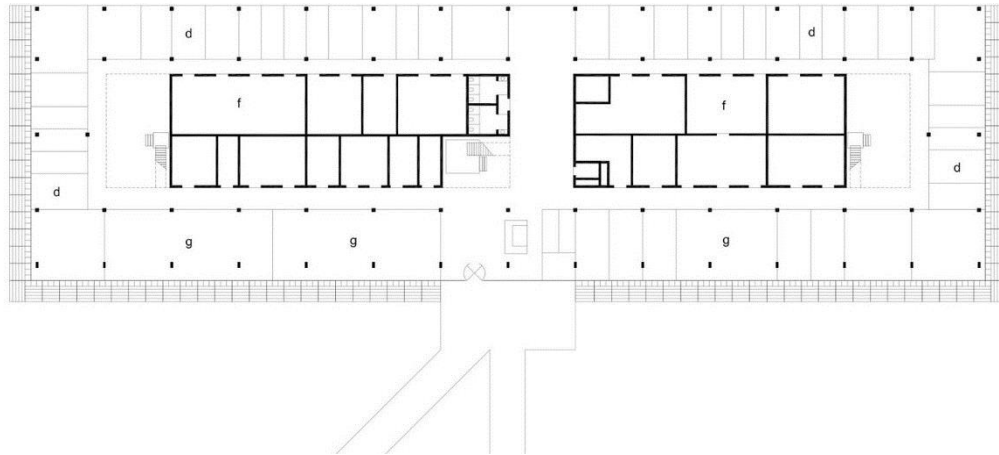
Planta baja del instituto holandés. Recuperada de <http://www.archdaily.mx/>
